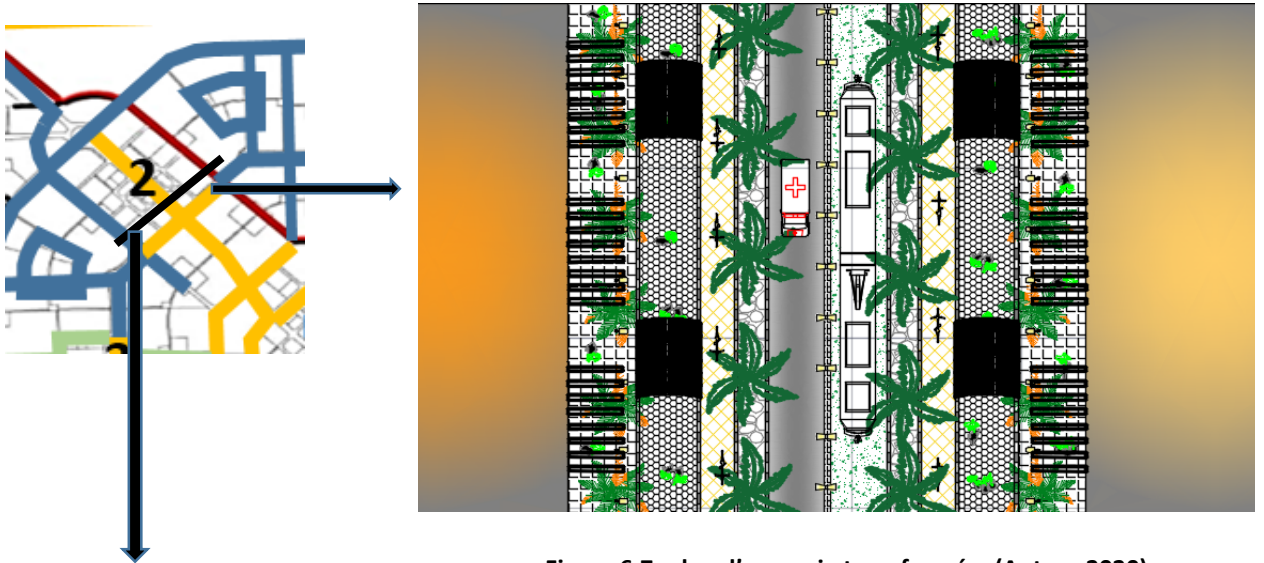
plan d'une voie transformée. (Auteur 2020)
